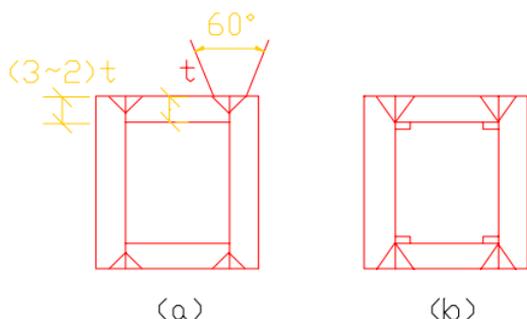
箱形组合柱的角部组装焊缝
